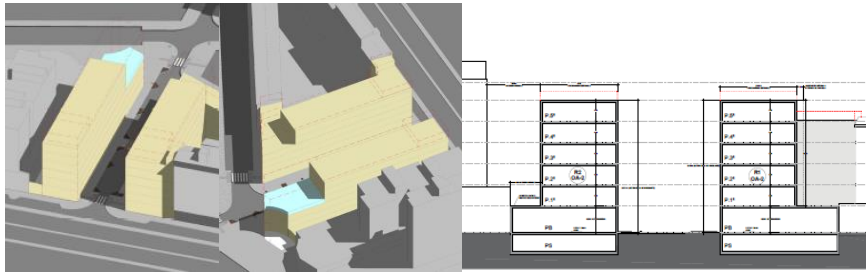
, 6. Ordenación volumétrica propuesta en el ED Imagen 7. Sección. Alturas sobre y bajo rasante
